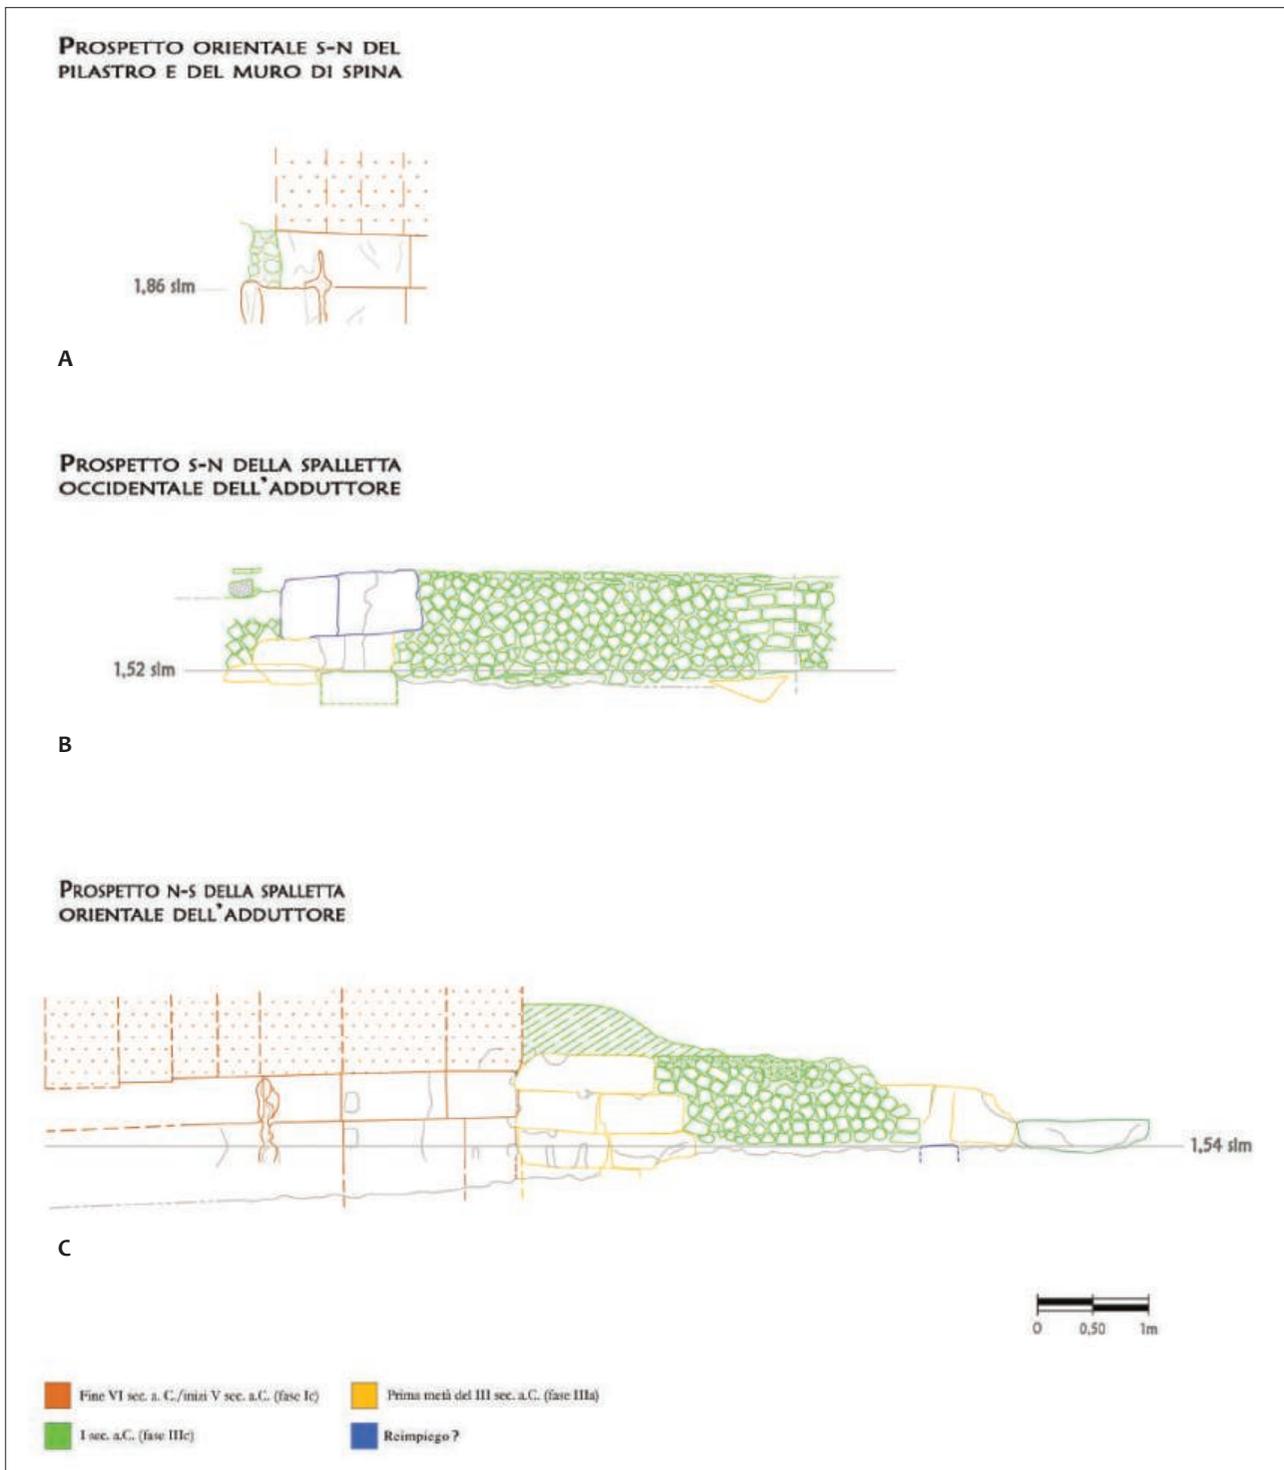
La struttura del collettore, con indicazione delle fasi tardo-arcaica, ellenistica e tardo-repubblicana: a. il muro di spina – prospetto da Est; b. la spalletta occidentale – prospetto; c. la spalletta orientale – prospetto (rilievo: C. Penzone)
